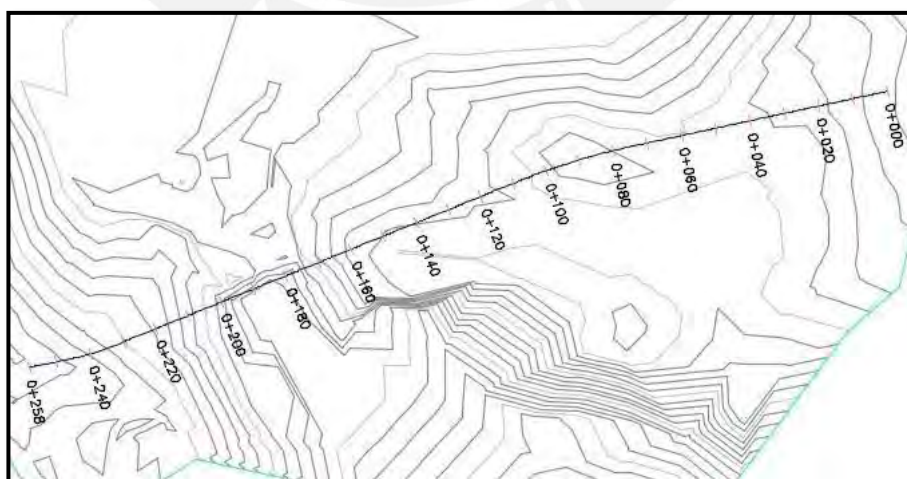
Alineamiento en planta de futura represa en Civil 3D (elab. propia)
